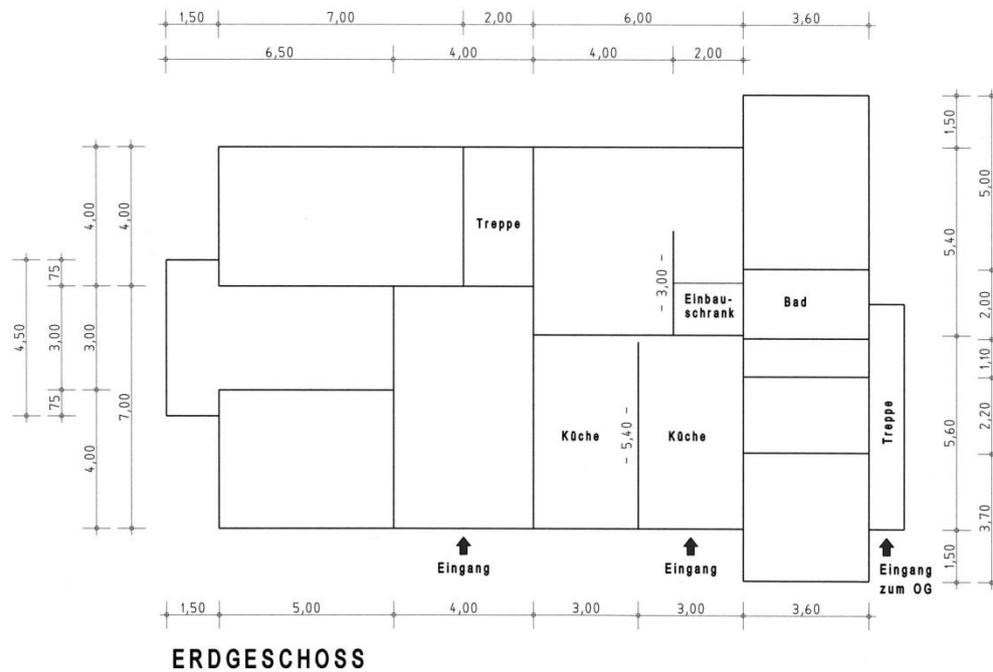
Plano de la planta baja. Fuente: VETH, Margarete.
